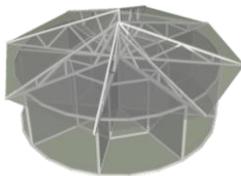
Struktur kestabilan antara kolom dan lantai diafragma. Sumber: penulis
